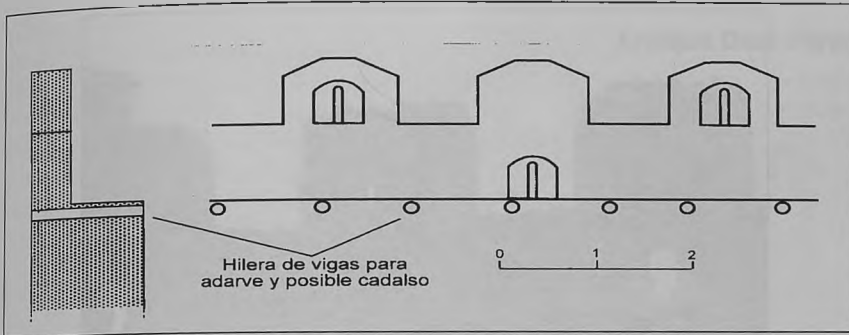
Castillo de Bijuesca: sección y alzado de la zona alta de uno de los muros del recinto superior; parapeto almenado con saeteras de disposición alternante y mechinales bajo el suelo de obra
